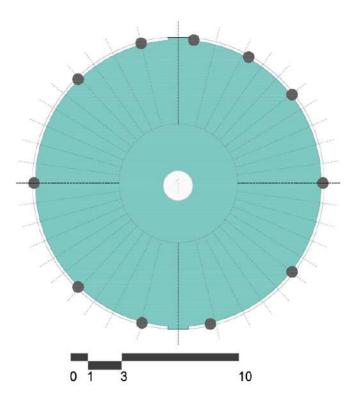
Planta 1 Bloque 50. Fuente: Equipo de diagnóstico.
